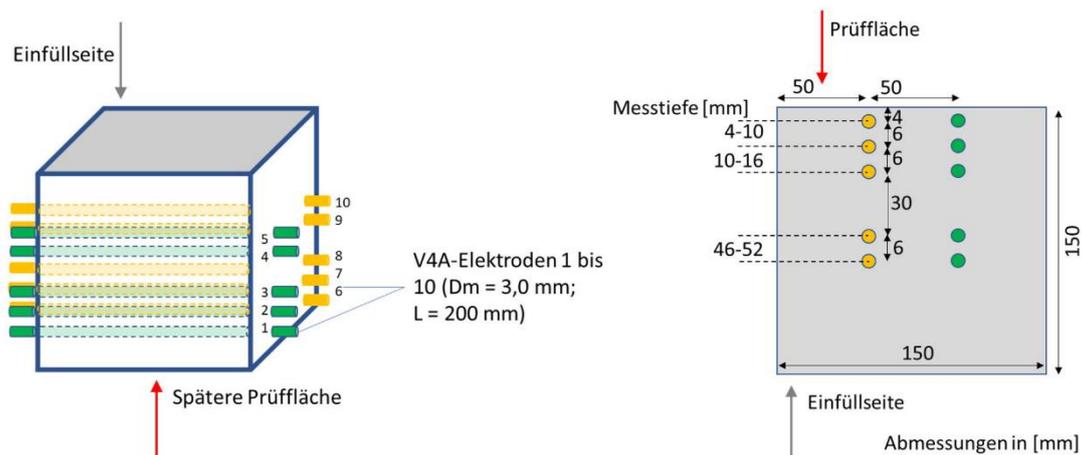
Skizze zu den Probekörpern mit eingebauten V4A-Elektroden; links: Frontalansicht, rechts: Seitenansicht
